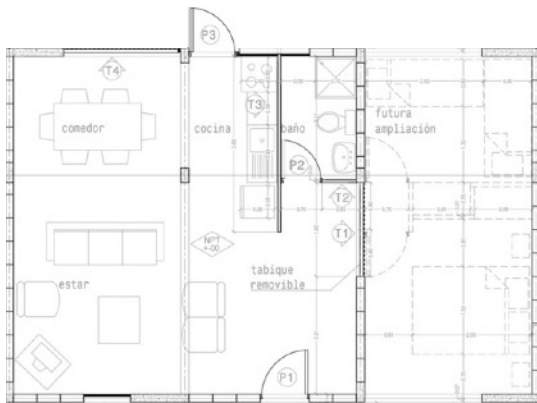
Planta baja y sus posibles ampliaciones; Alejandro Aravena
